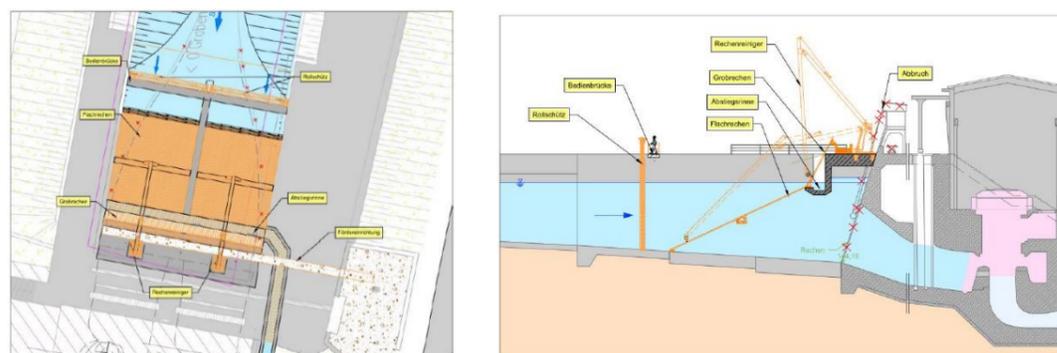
Alternative 2 – Plan de situation et coupe longitudinale
